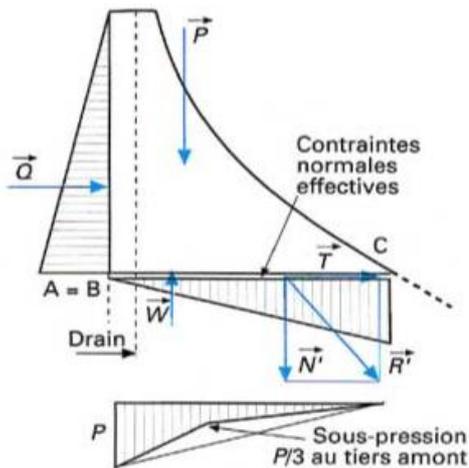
Effet du drainage sur l'équilibre (technique de l'ingénieur)
